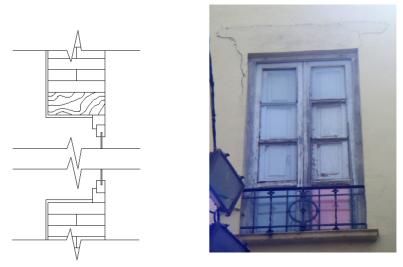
y 56. Encuentro de muro con ventana, enfoscado. Fuente: Edición propia
